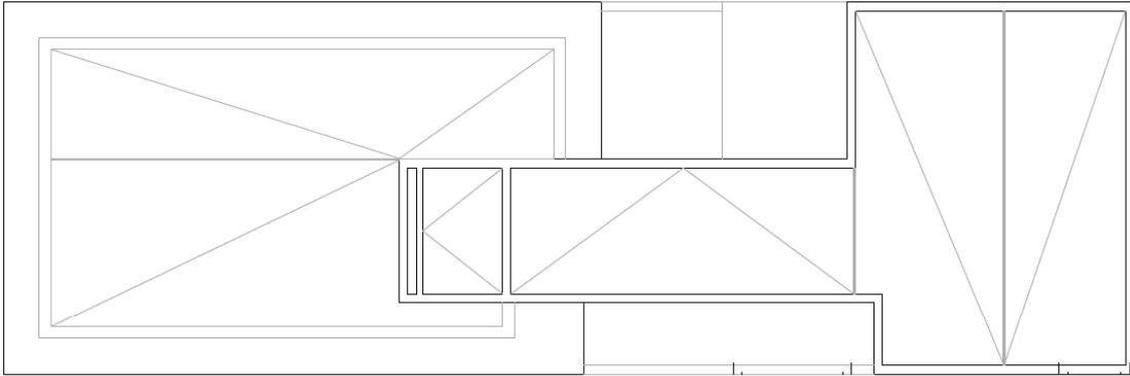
Plano de la Planta Cubierta de la vivienda. Vista: En Planta
